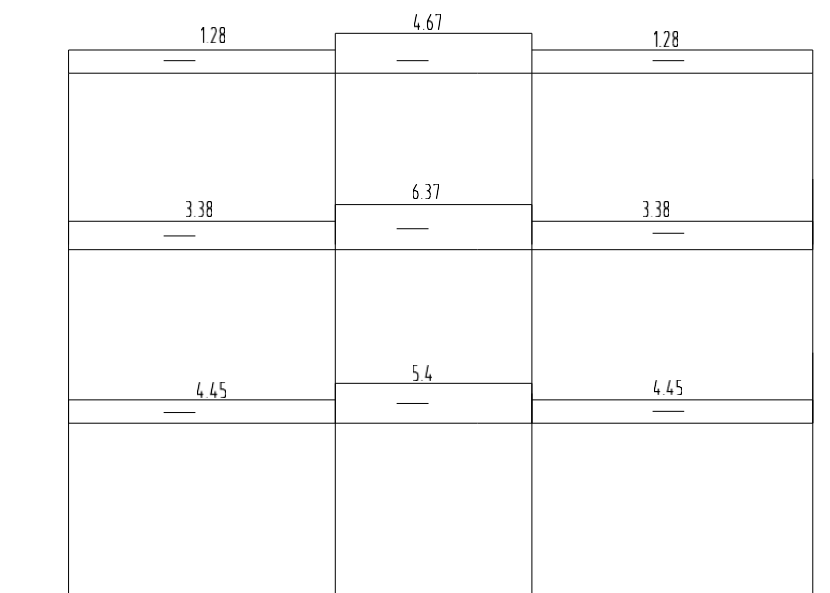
Сила поперечного сечения балки (кН) при ветровой нагрузке
